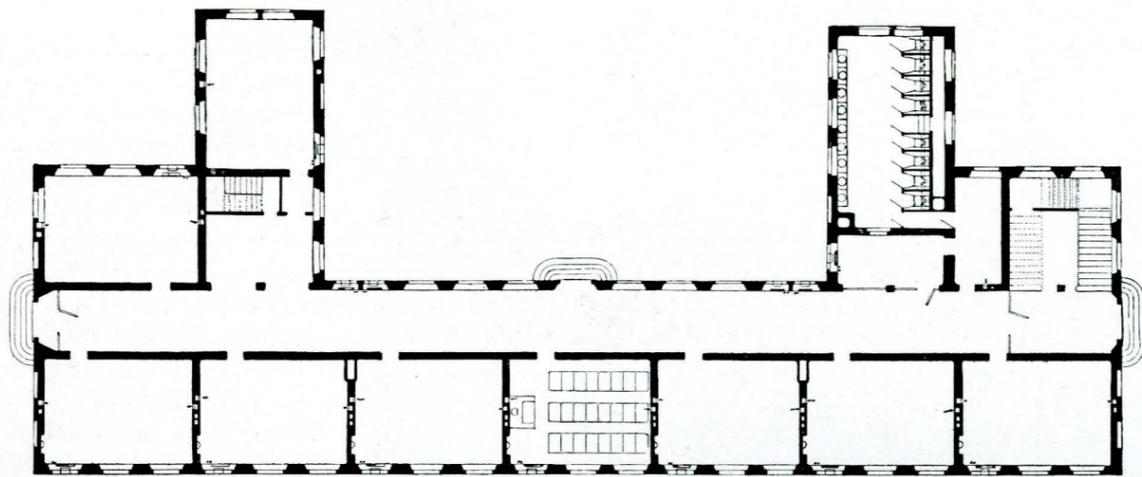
Edificio Scuole « Al Piacentino ». Pianta del piano terreno (Scala 1 : 400).
